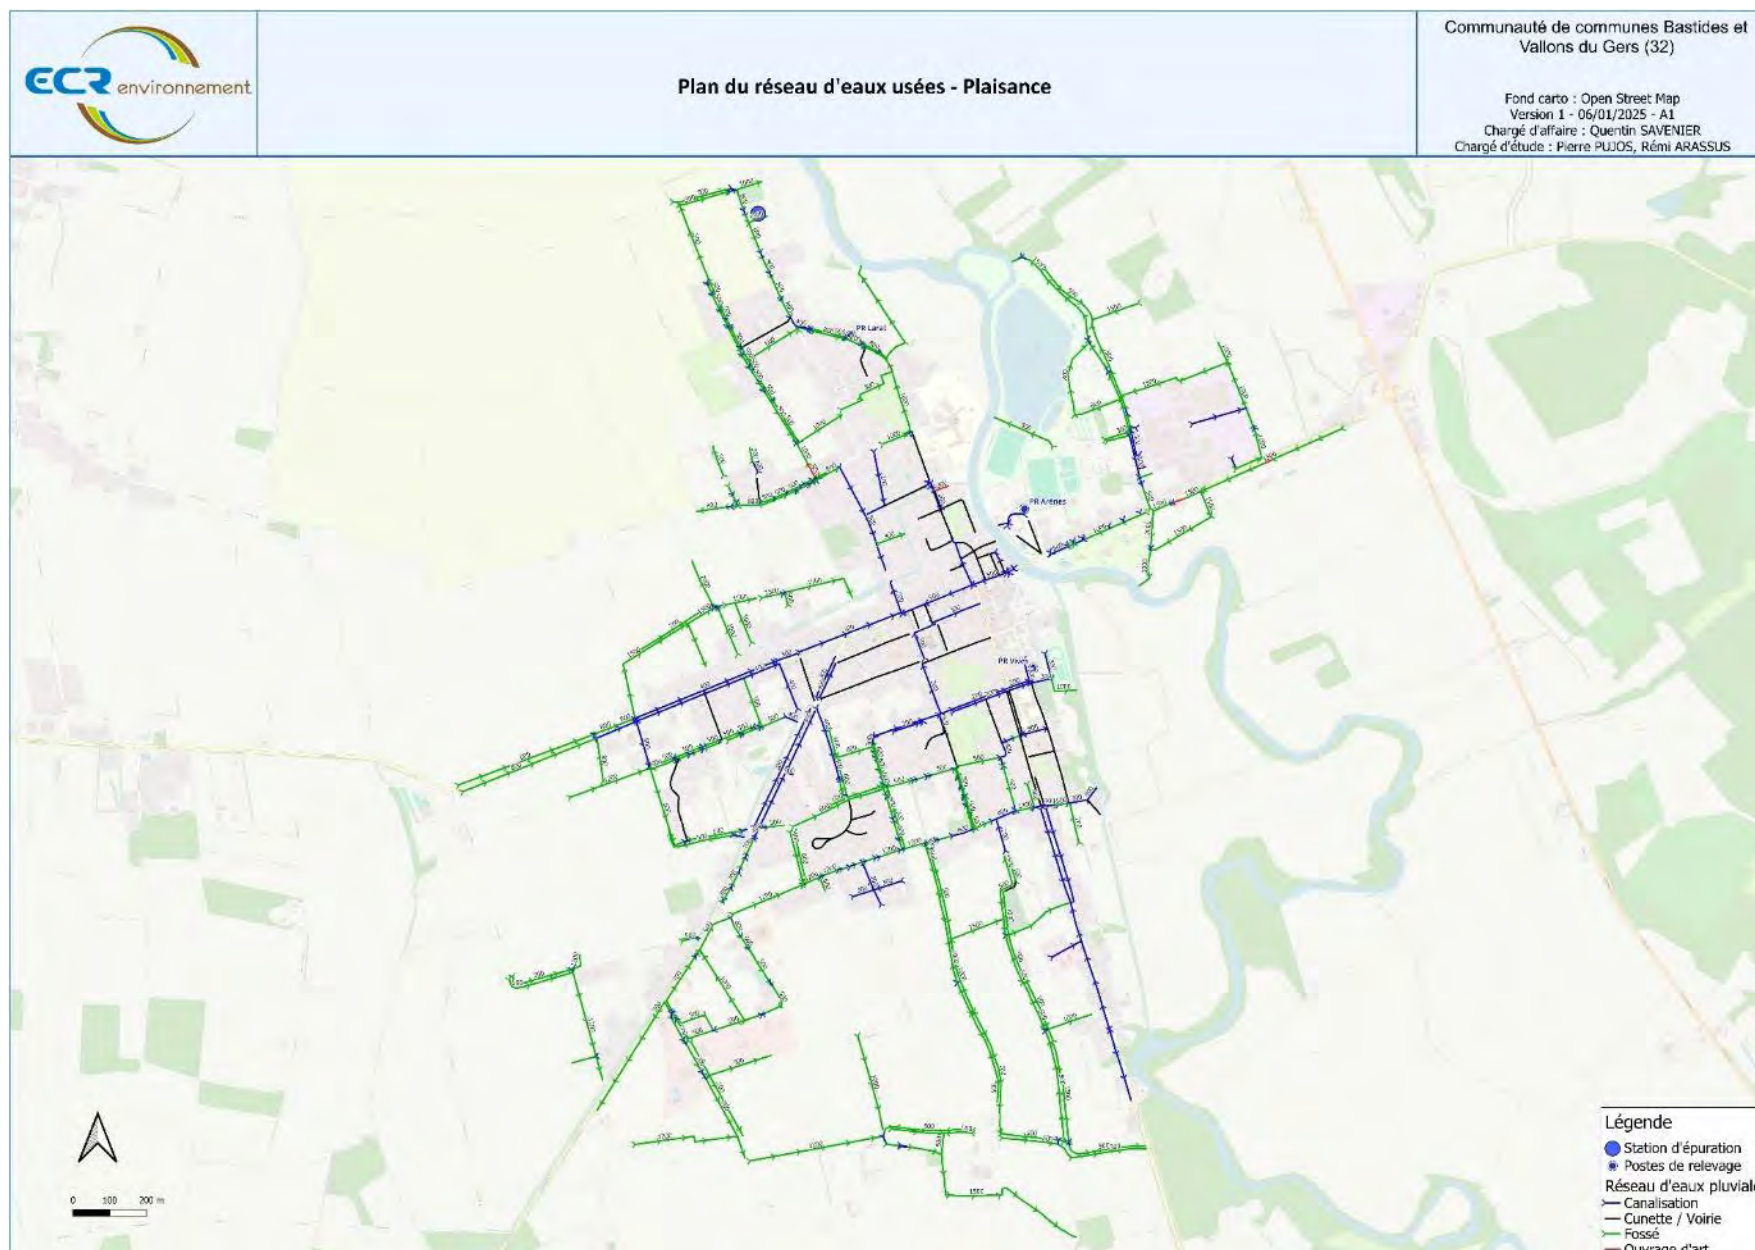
Plan du réseau d'eaux pluviales de Plaisance, source ECR
